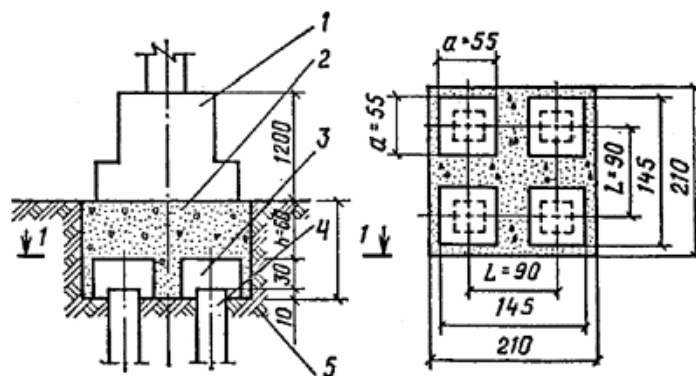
Схема свайного фундамента с промежуточной подушкой:
